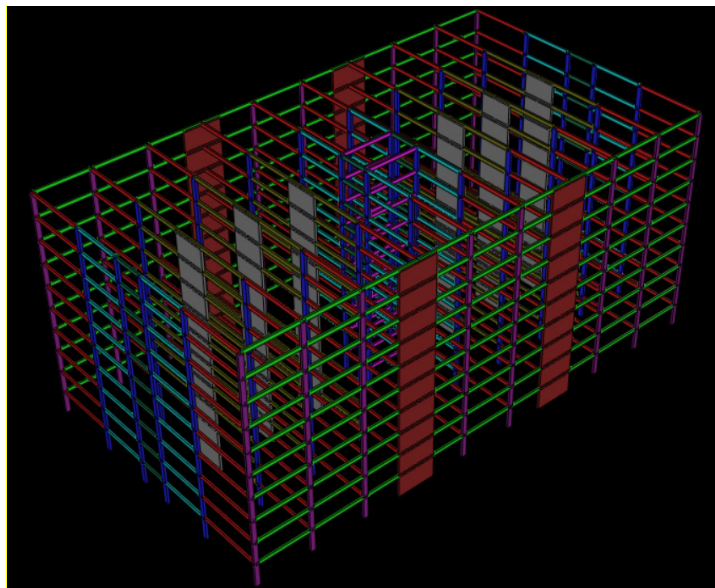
Pórtico espacial do edifício garagem contraventado por pilares-parede.
